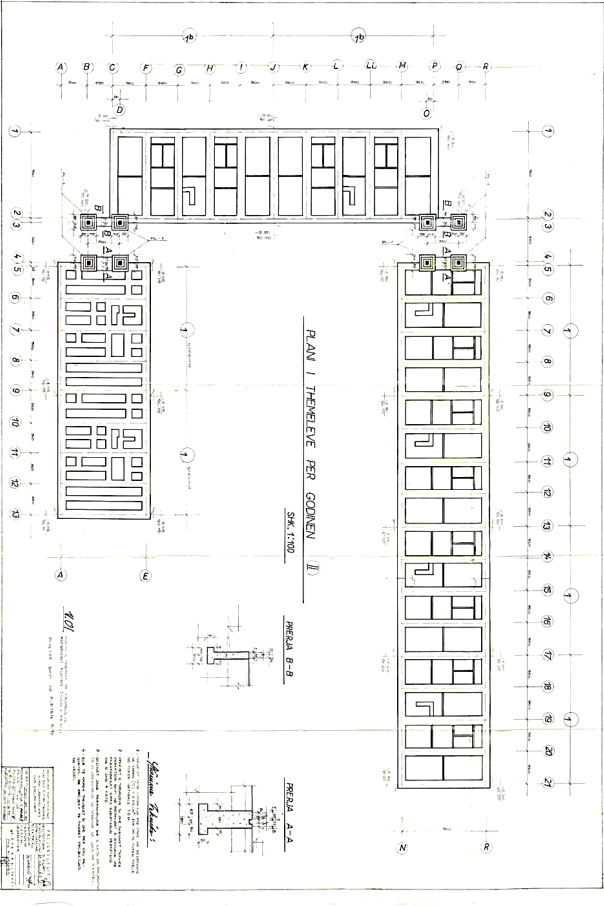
Pianta iniziale delle fondazioni dell'edificio preso come caso studio nel quartiere n.9 [AQTN]
